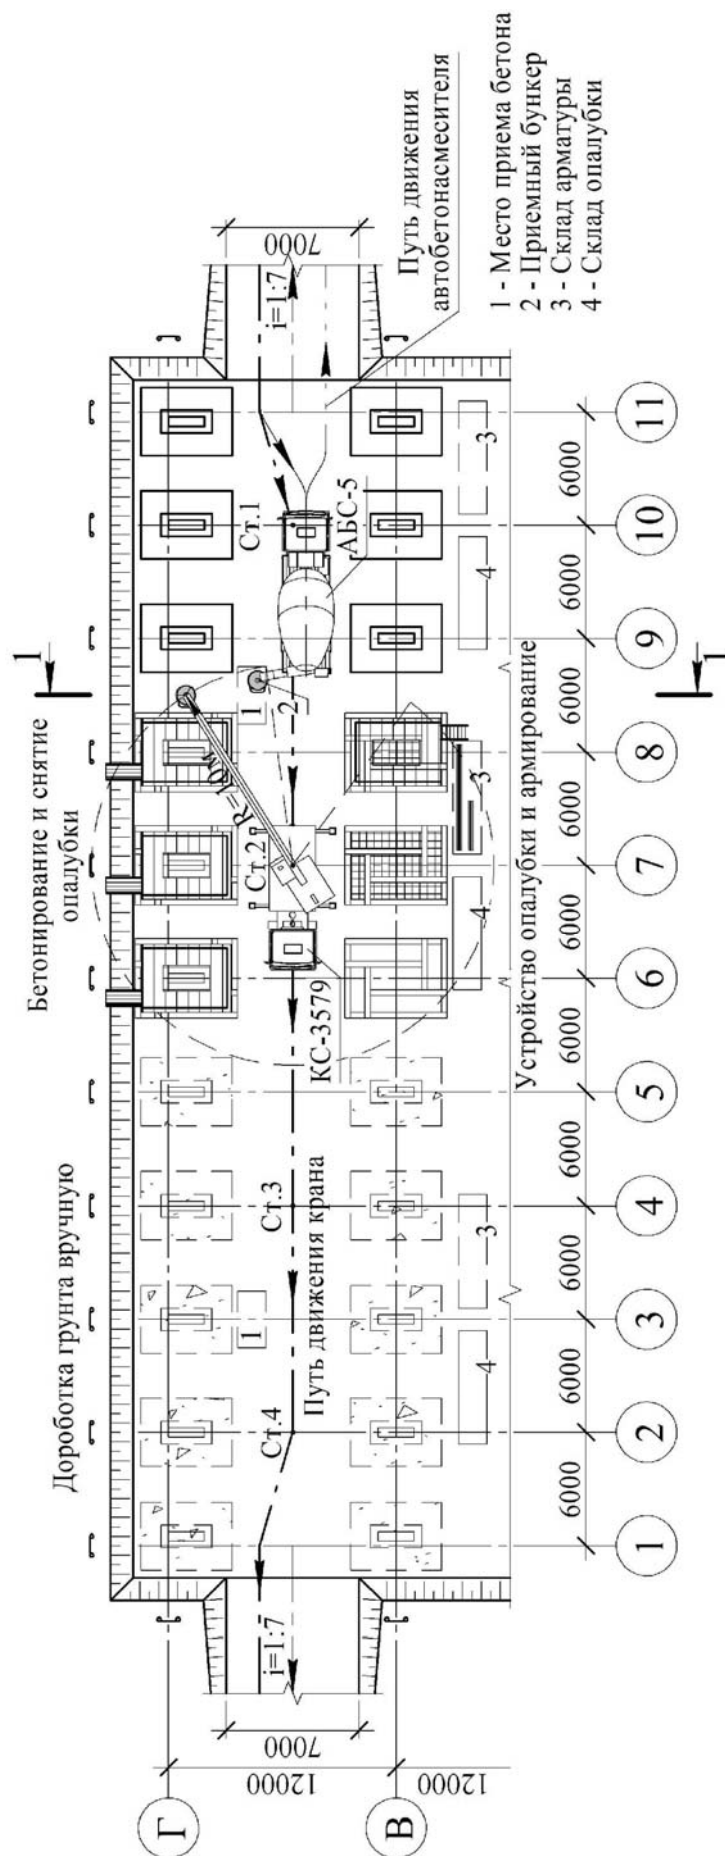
Схема организации работ по устройству монолитных столбчатых фундаментов в котловане
